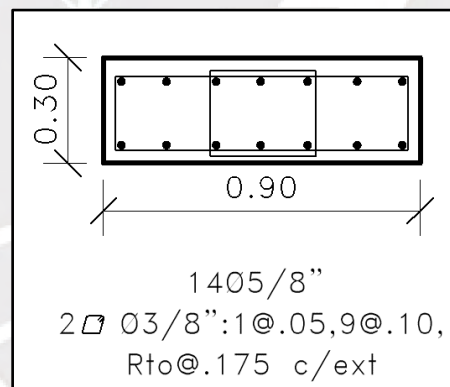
Armado final (estribos y acero longitudinal) de la columna central
